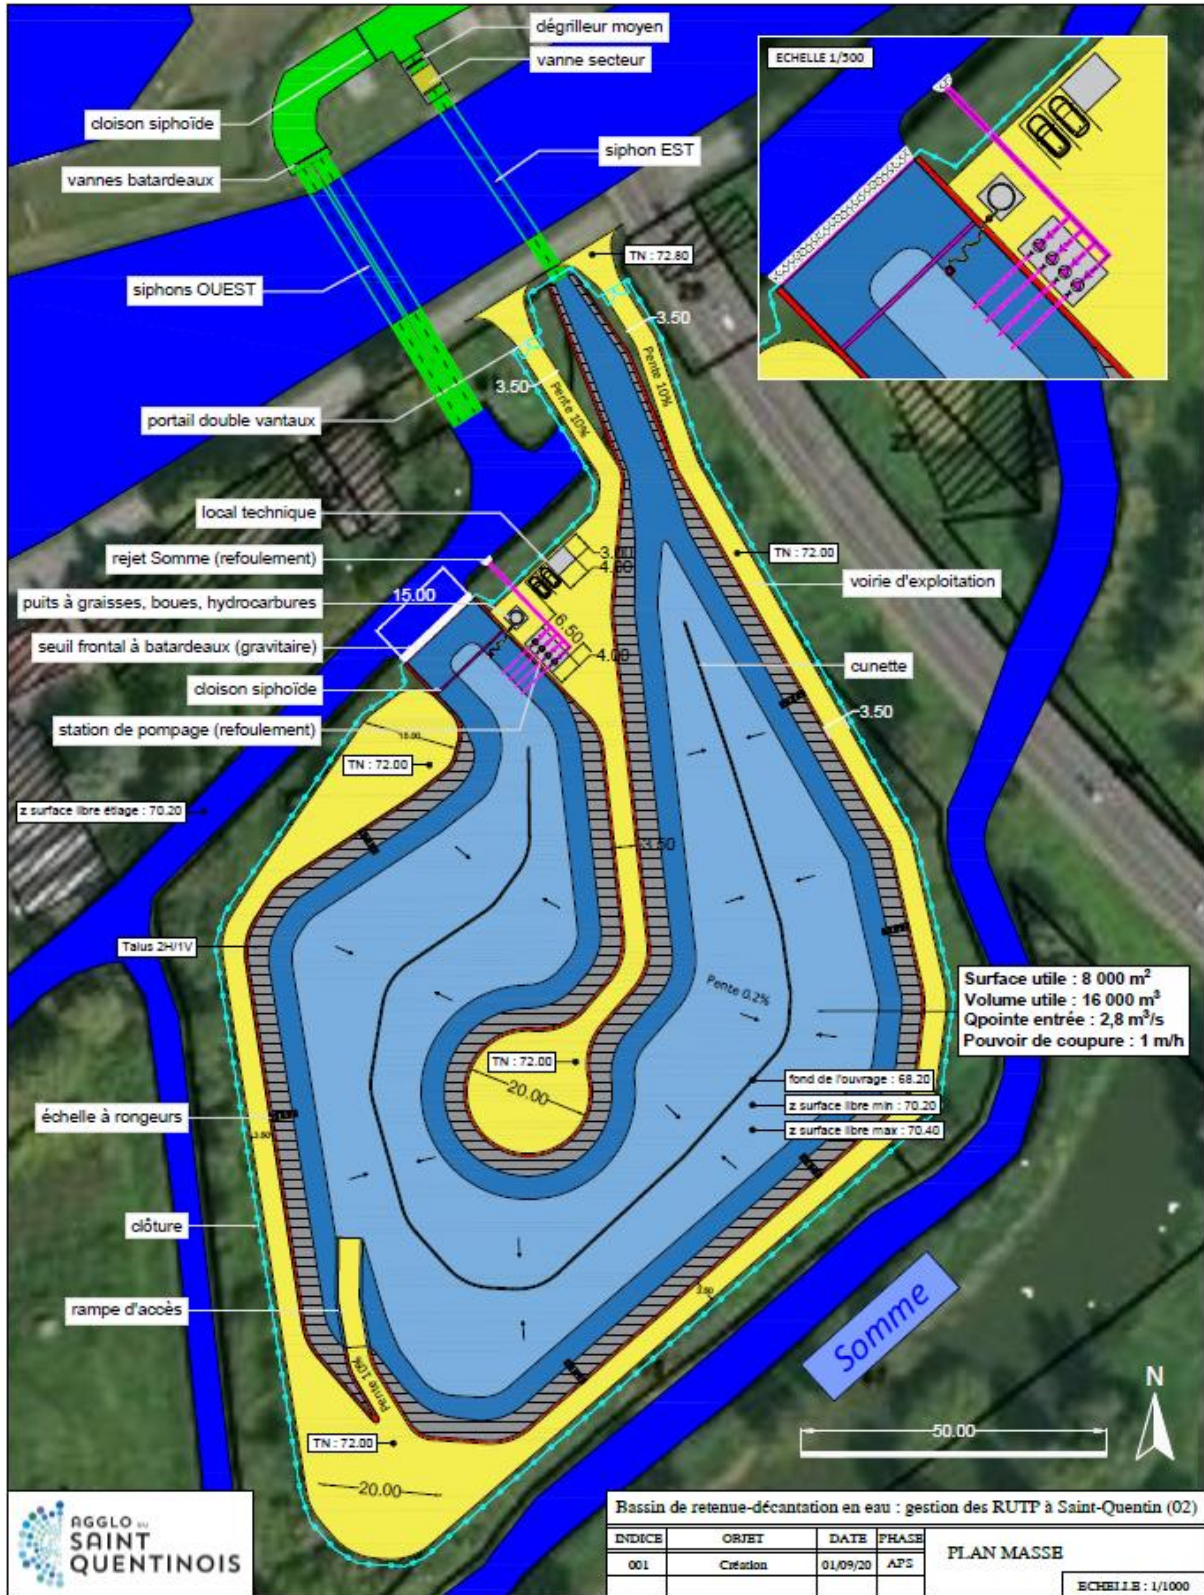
Plan de masse du bassin de retenue-décantation en eau projeté
